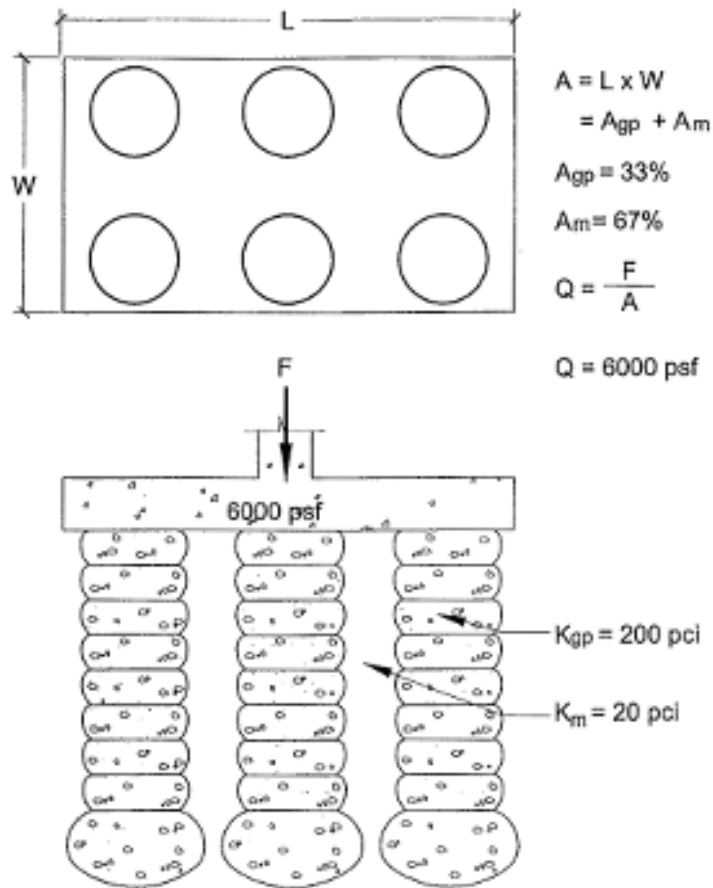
Diseño típico del elemento Geopier bajo una base de columna aislada, Adaptado de "GEOPIER foundation And Soil reinforcement manual" por Fox and Comwell (1998).
